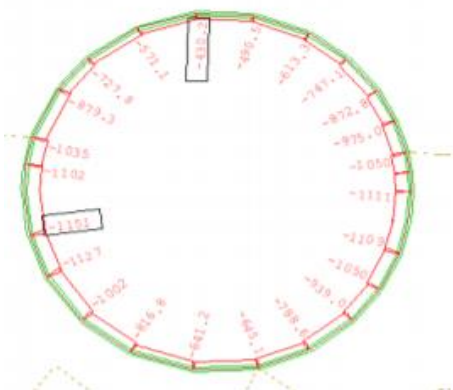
Эпюра продольных усилий, возникающая в конструкции железобетонной обделки на стадии завершеного строительства тоннеля в разрезе
